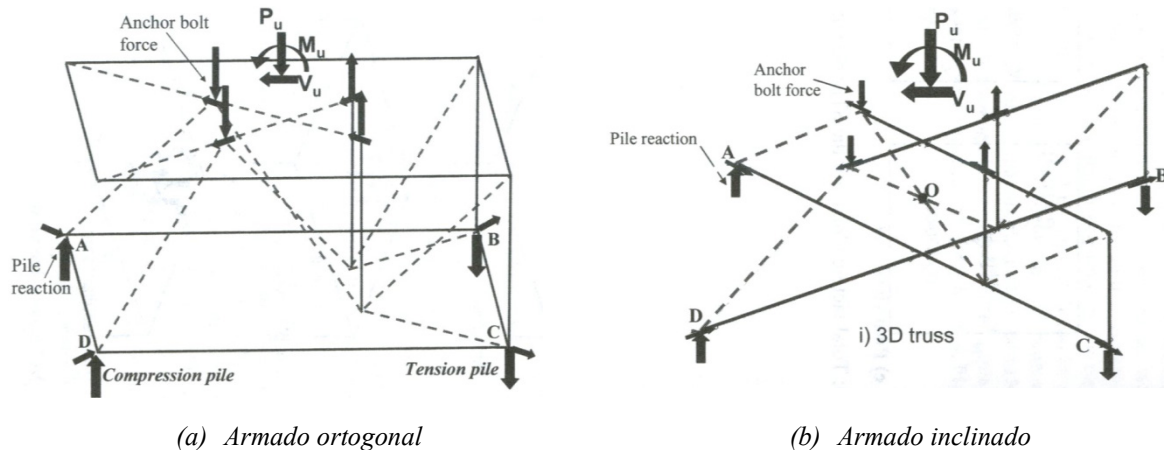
Modelo de BT para encepado con pilote en tracción [4]
